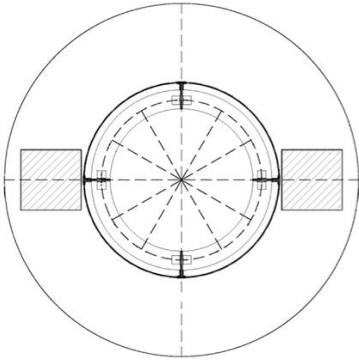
Detalle en planta del prototipo de los pozos de luz.
